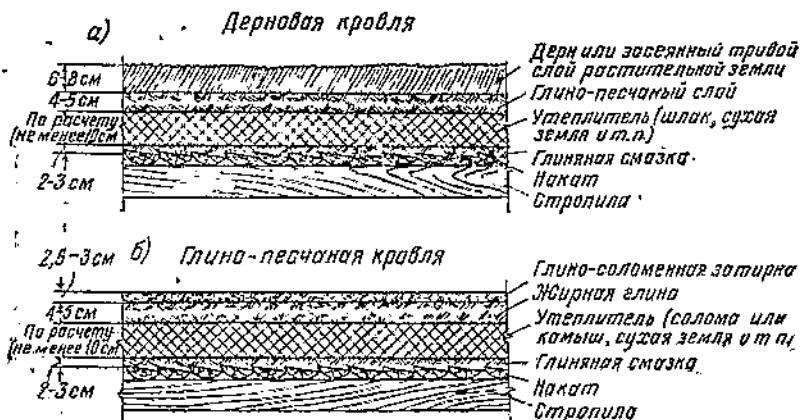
Кровли из грунтоматериалов для покрытия землянок и полуземлянок.
